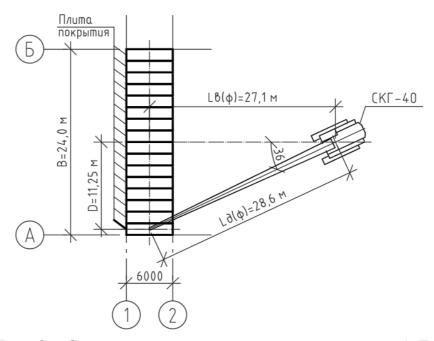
Схема монтажа крайней плиты в пролете А-Б
